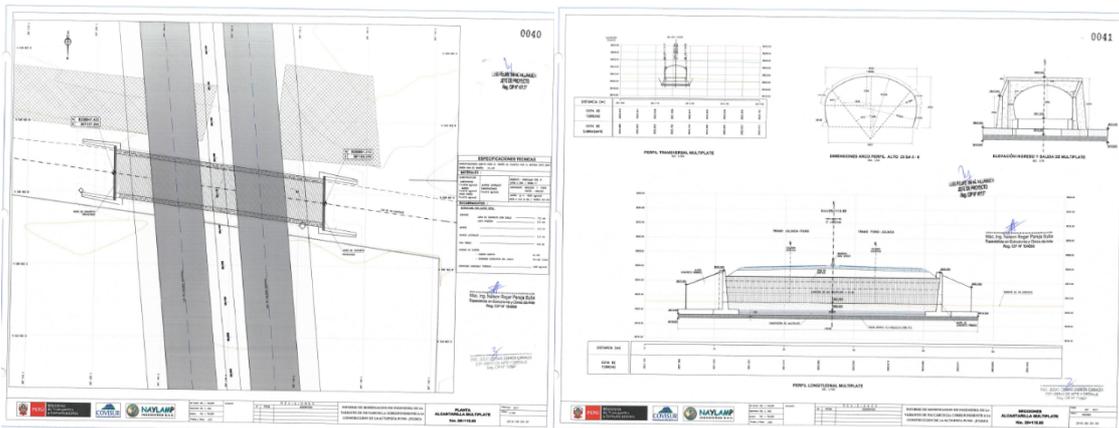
Plano Planta y Sección Intercambio Vial. Fuente, Expediente Técnico: Informe de Modificación de Ingeniería de la Variante de Paucarcolla correspondiente a la Construcción de la Autopista Puno - Juliaca
